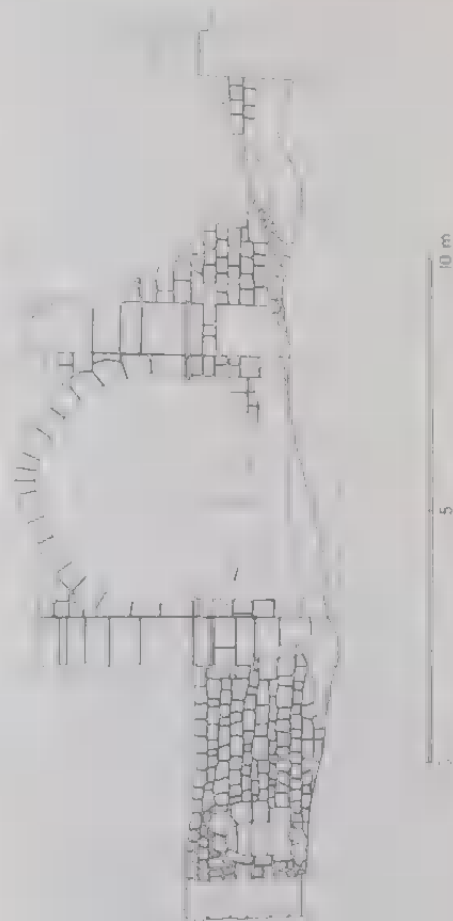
Kirche 1, Langhaus mit Vierung, Restles Kirche 1, Südostansicht.
